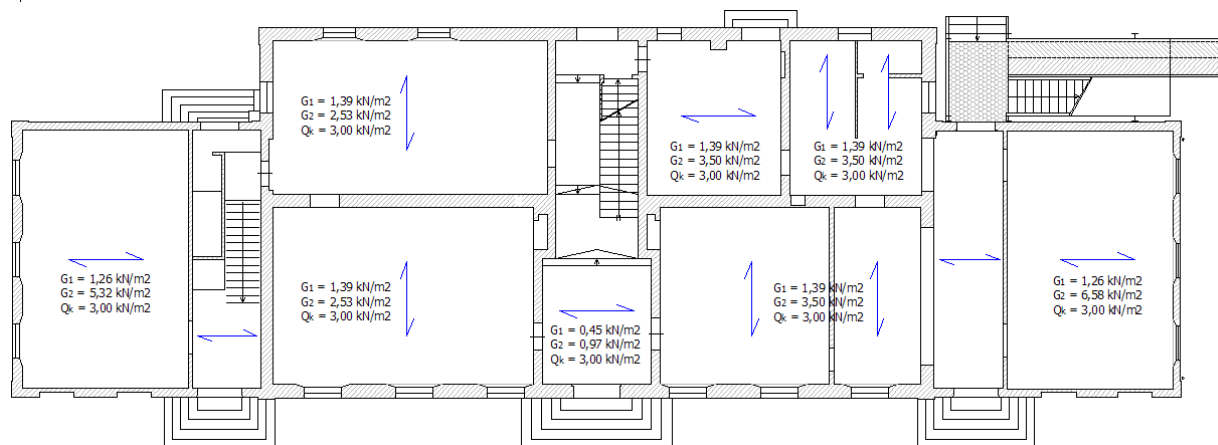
Carichi orizzontamento tra piano Rialzato e Primo
